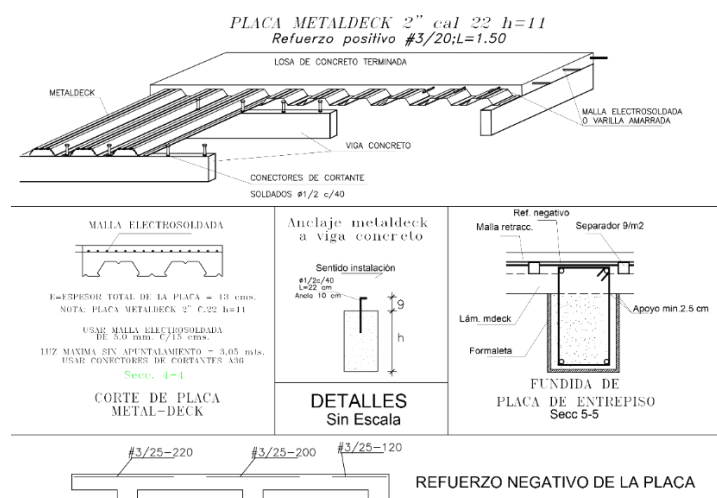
Archivos Planeación Municipal De Honda Tolima (2019) Detalles Placa De Entrepiso.
